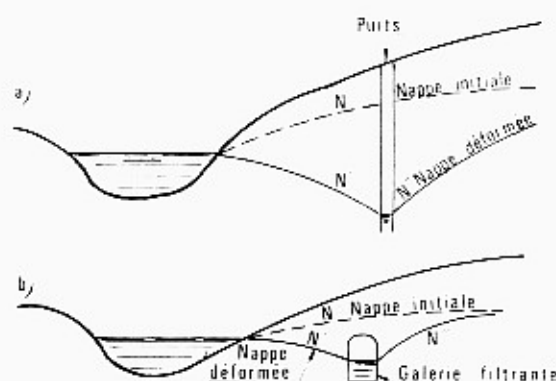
Déformation d'une nappe par pompage ou par drainage.
